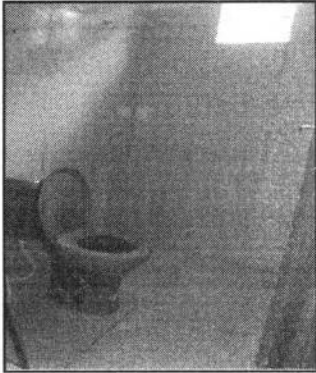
Vista da Banheiro, com destaque ao revestimento cerâmico em paredes e piso
